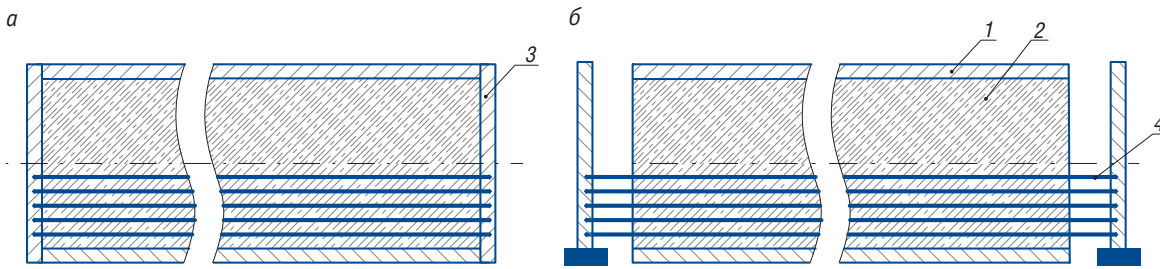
Способы реализации асимметричного предварительного напряжения в трубобетонных балках: а — с передачей усилия на бетон ядра 2; б — с передачей усилия на упоры 3; 1 — старогодная нефтегазовая труба; 2 — бетонное ядро; 3 — торцевой упор; 4 — армирующие элементы (только арматура для б, стальной трос или арматура для а)
